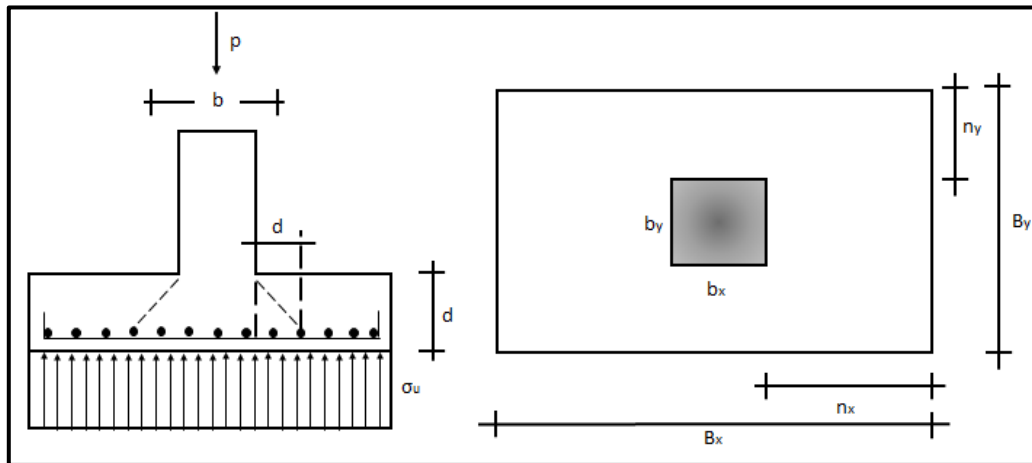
Plano de corte de una zapata aislada. Fuente: Autor
